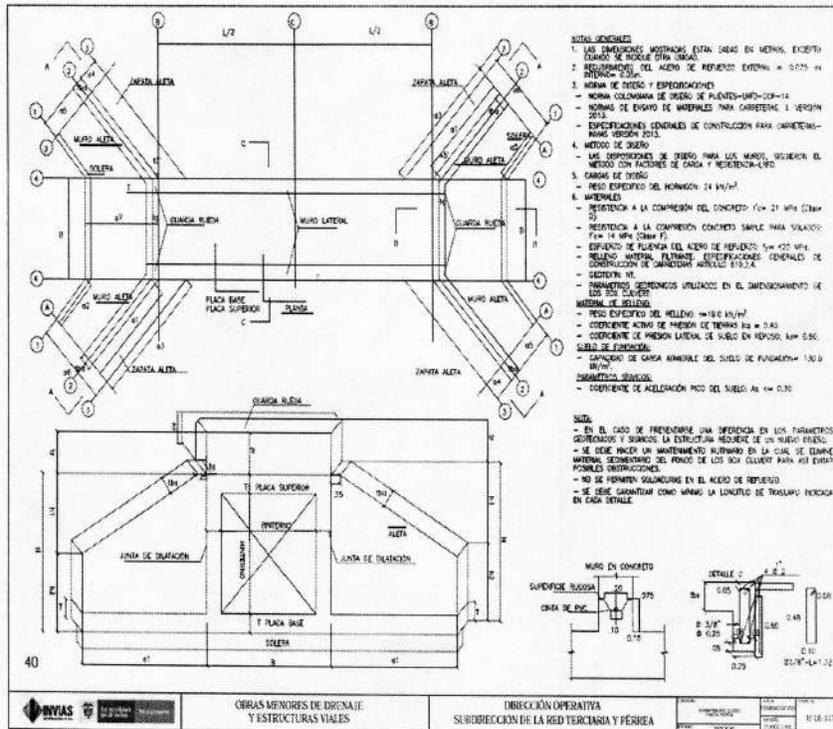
Geometría Box Culvert y Planta Frontal – Fuente: Municipio de Curumaní
